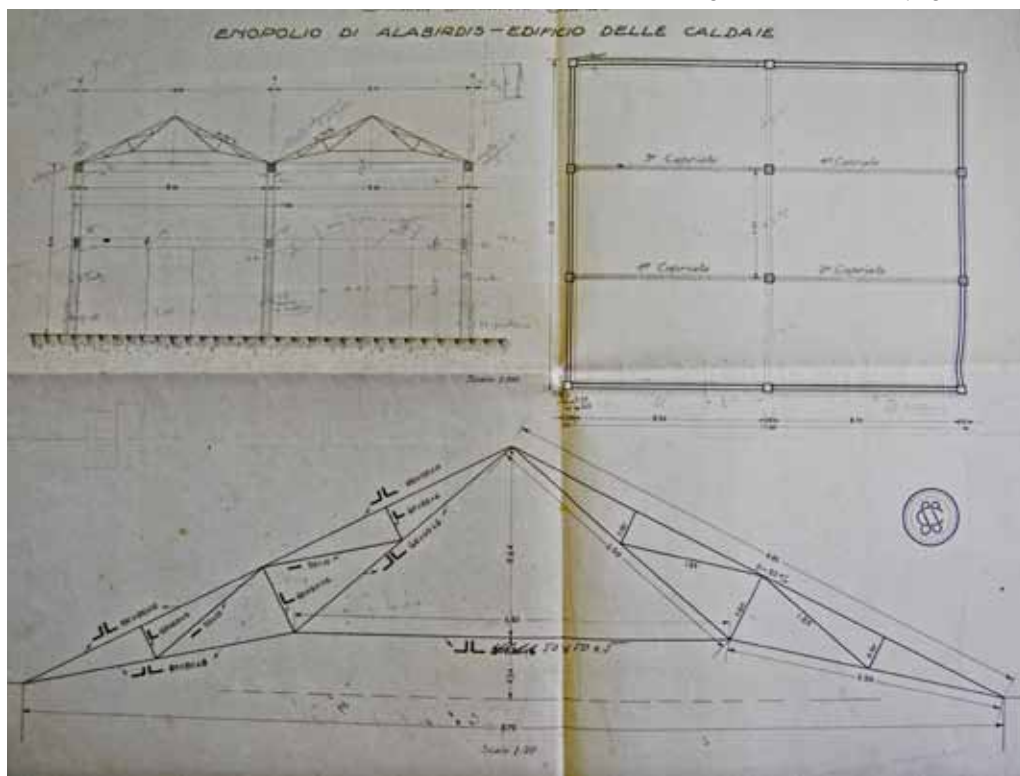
Progetto di ampliamento dell'enopolio. Pianta (a) e sezioni (b).
